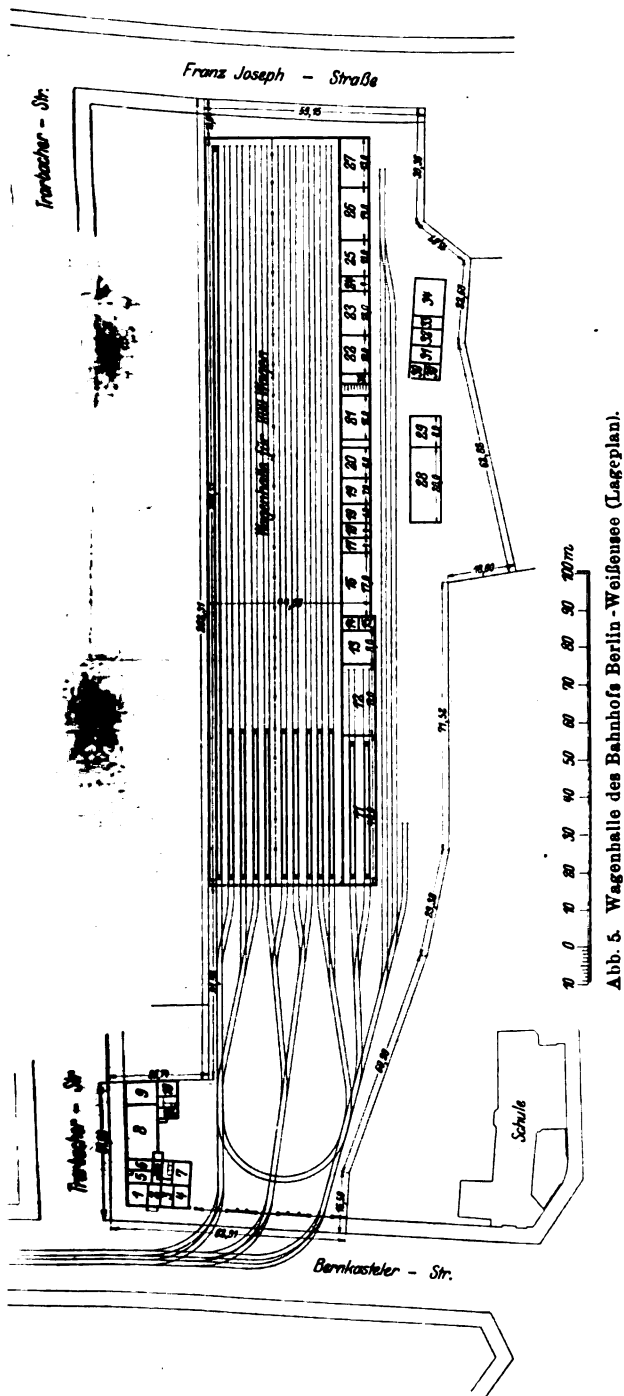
Wagenhalle des Bahnhofs Berlin-Weißensee (Lageplan).
